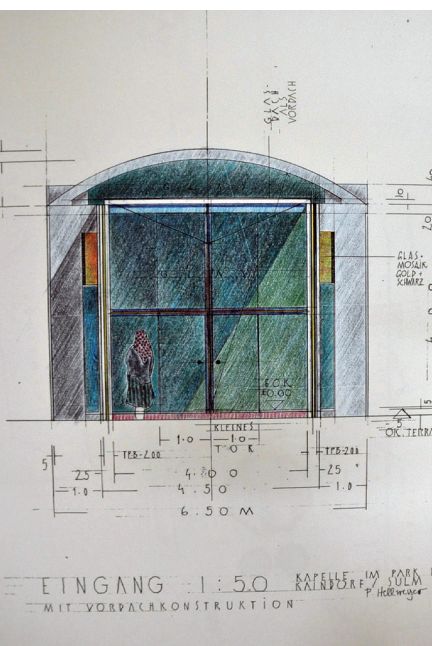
gezeichnete Ansicht der Kapelle mit seitlichen Betonwänden, mittiger Glasfassade, Eingangsportal und aufgesetztem, gebogenen Dach
